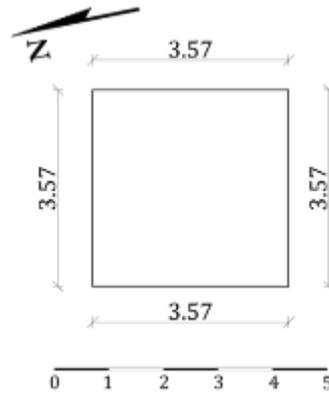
مسقط أفقي لدهليز المدخل بمدرسة السلطان حسن (عمل الباحثة)
